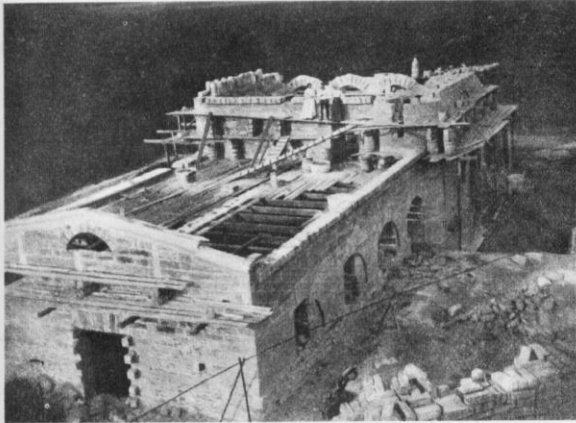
Подвалъ Станціи. Каменная кладка близится къ концу. Одноэтажная часть подвала уже готова; ведется кладка продольныхъ стѣнъ дробильнаго отдѣленія, фронтоновъ и верха круглой лѣстницы. Начата (первый планъ снимка) штукатурка фасада со входомъ въ подвалъ.
